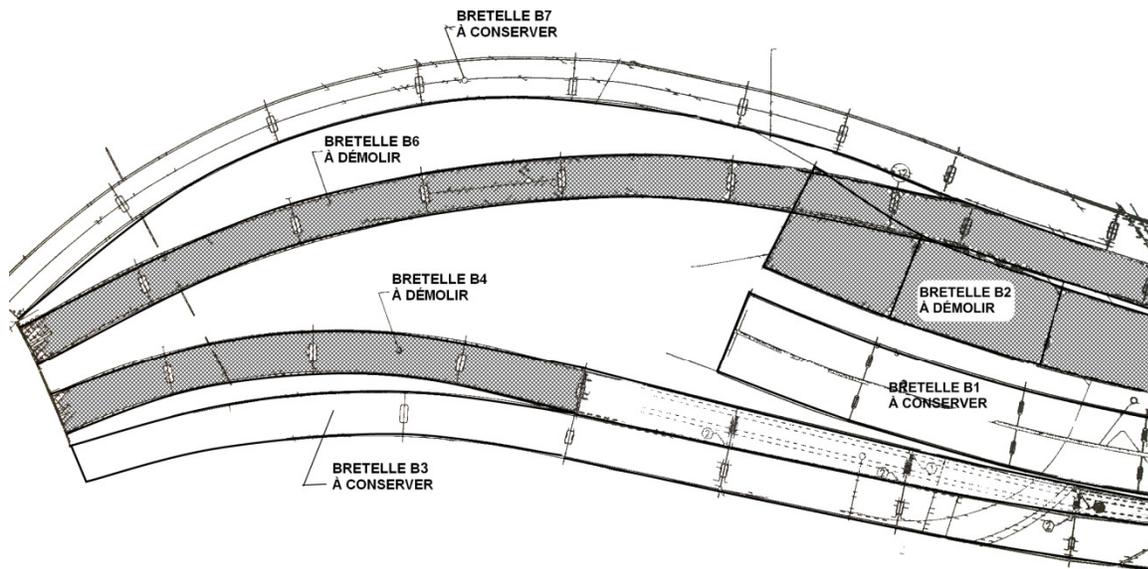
Plan de démolition des bretelles de l'autoroute Dufferin-Montmorency
